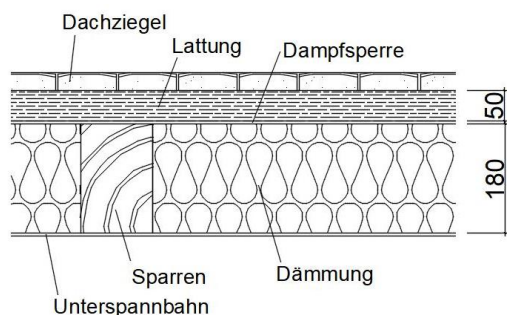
Aufbau Dachkonstruktion mit Dämmung
